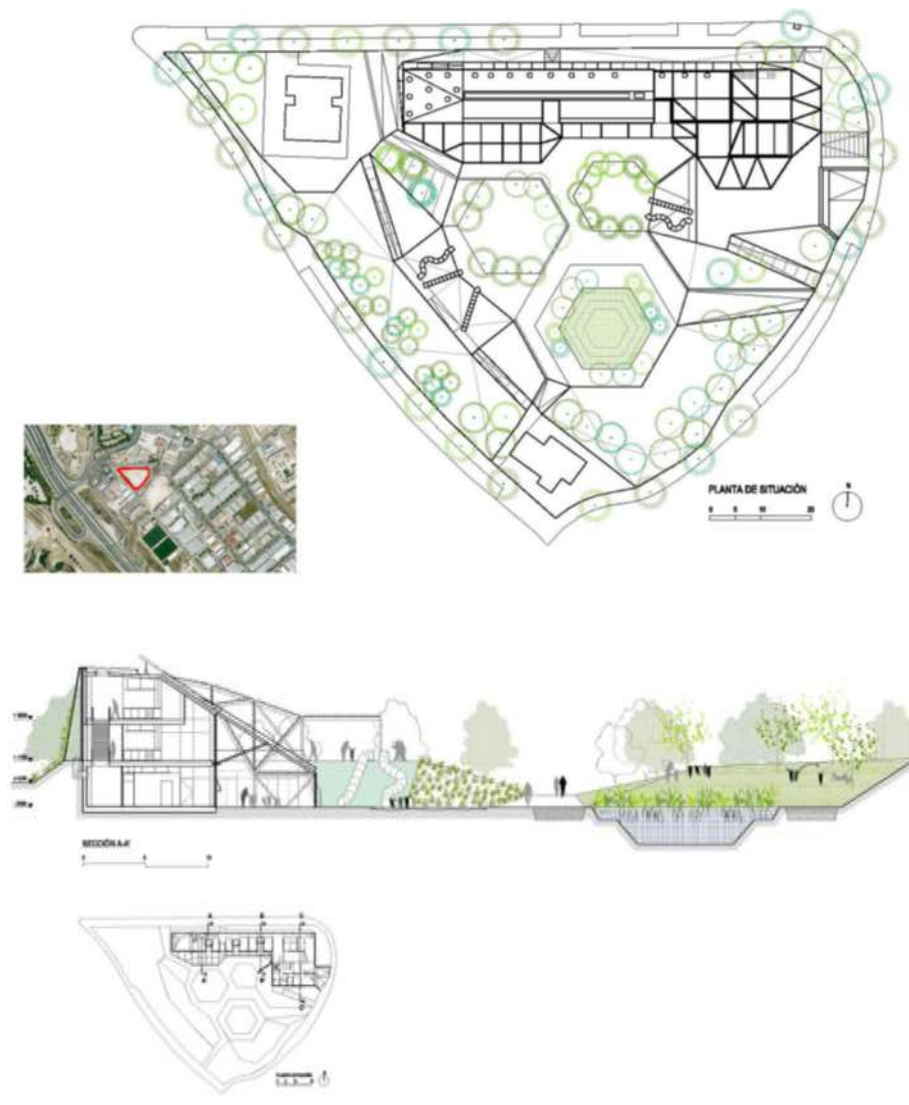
Planta y corte del proyecto Plaza Ecópolis. Fuente: Ecosistema urbano (2017).
